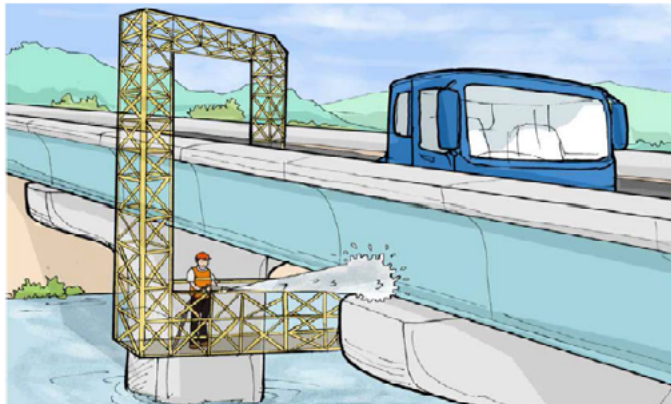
Limpieza de las vigas con la ayuda de un vehículo de inspección.
